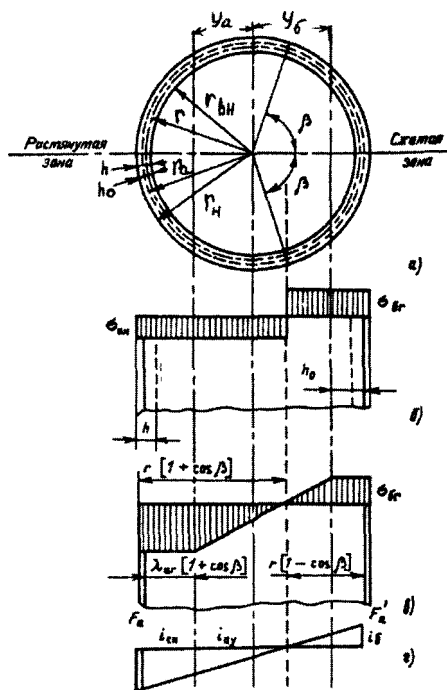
Расчетная схема с ненапрягаемой арматурой:
